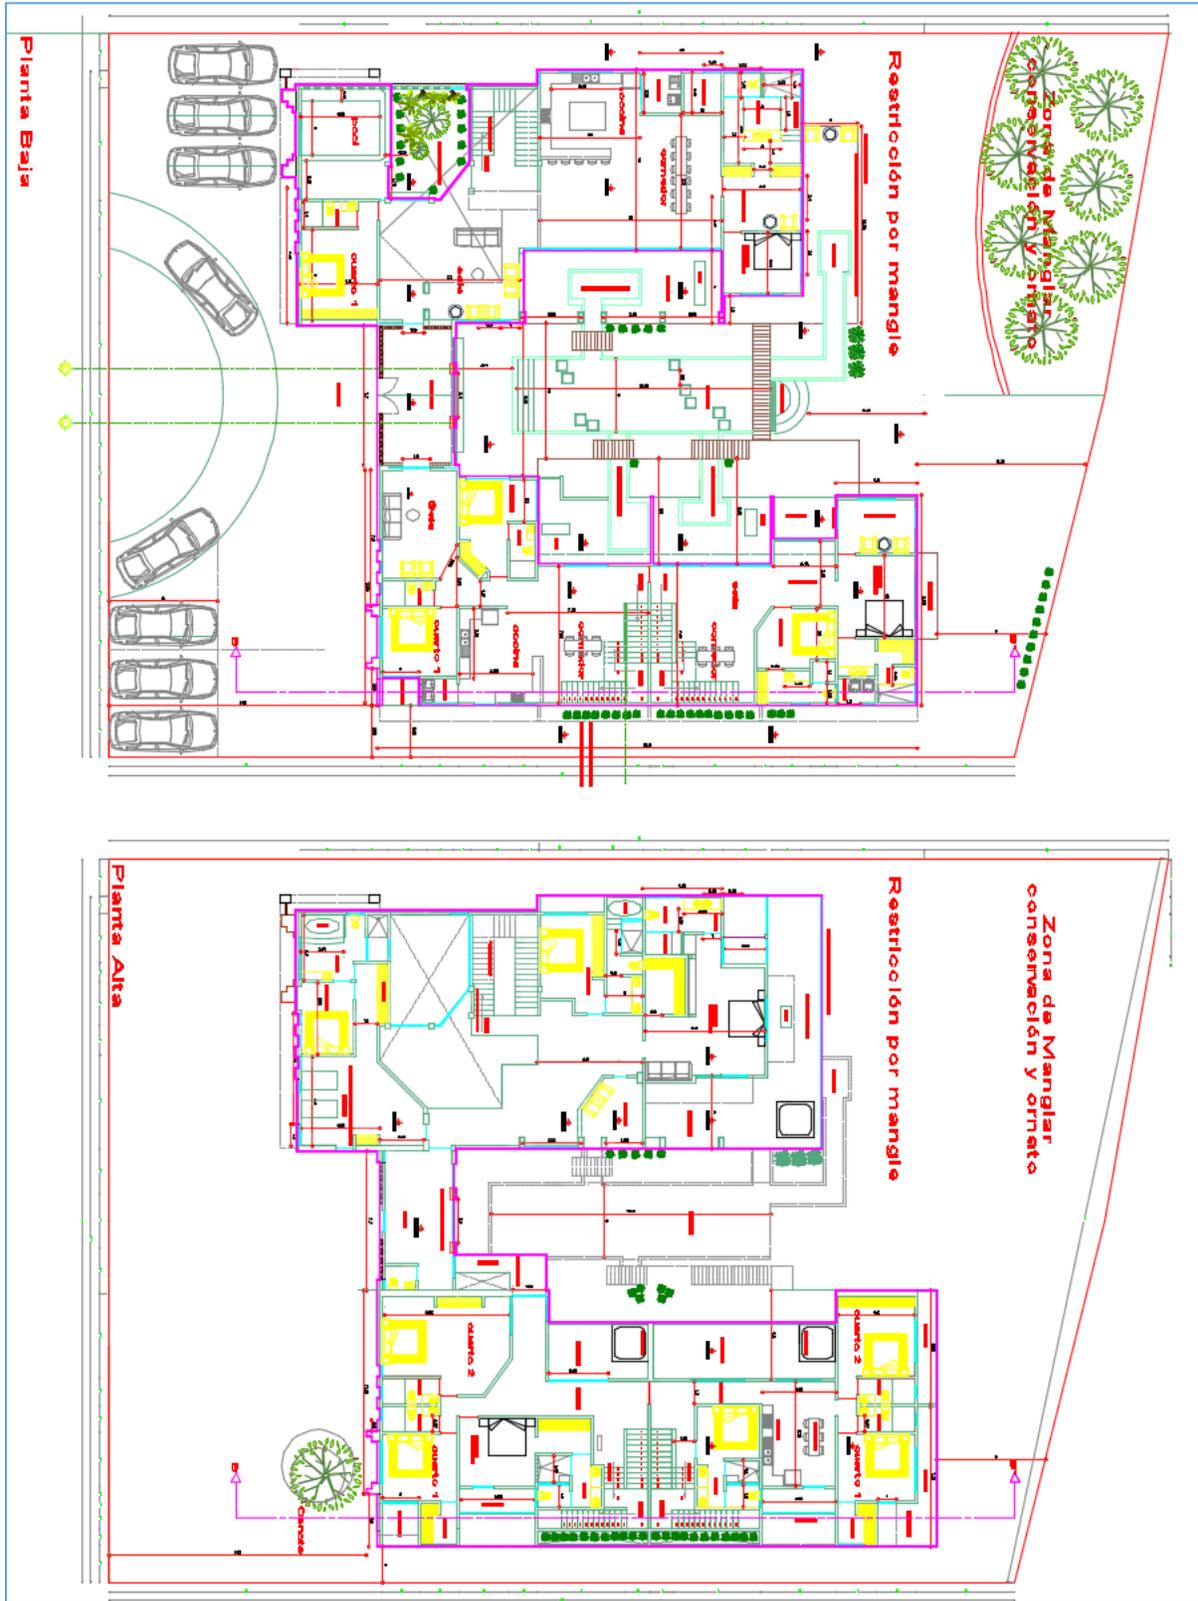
Se muestra en plano arquitectónico de la distribución de las obras en planta baja y planta alta
